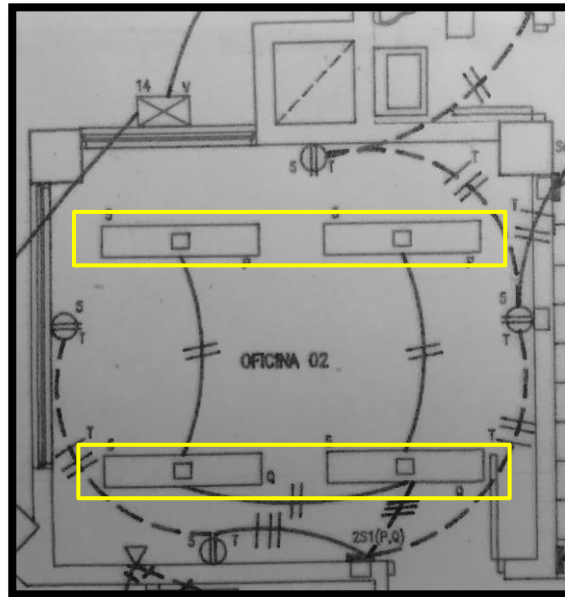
Cornare. (2008). Plano de Distribución del Sistema Eléctrico Planta Primer Piso.
